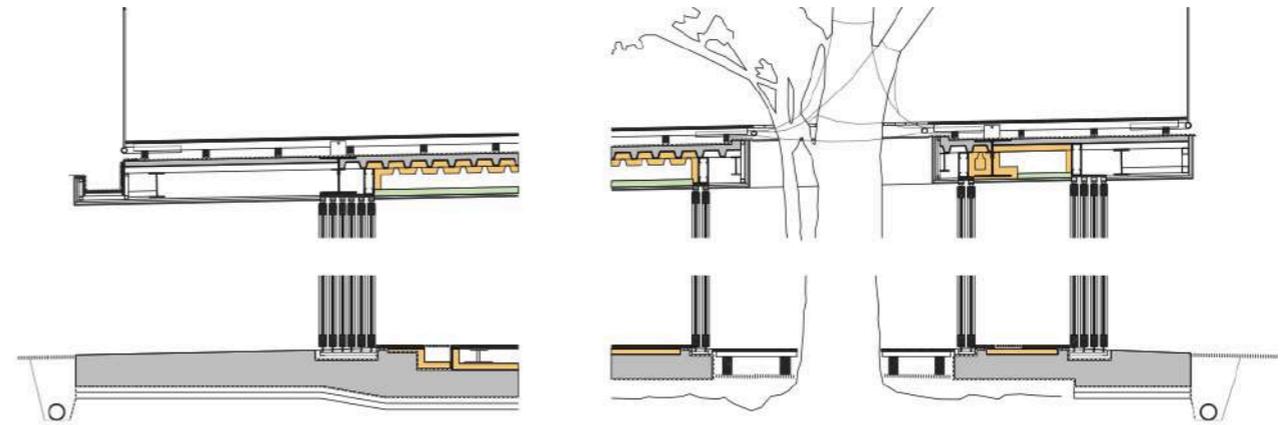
Sección con detalles constructivos de recogida de aguas y cubierta con arboles atravesando. Fuente: <http://www.tezuka-arch.com/works/education/fujiyochien/>
